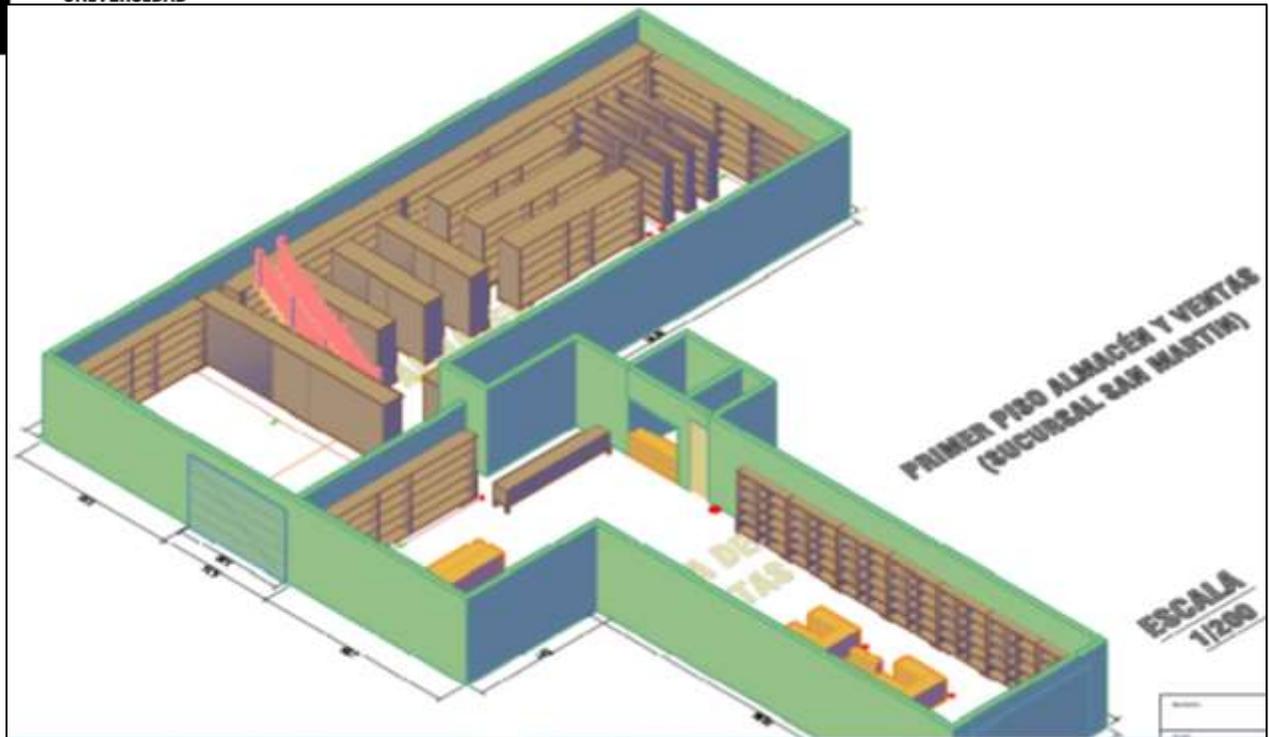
Layout del primer piso empresa DIFESA, en 3D
